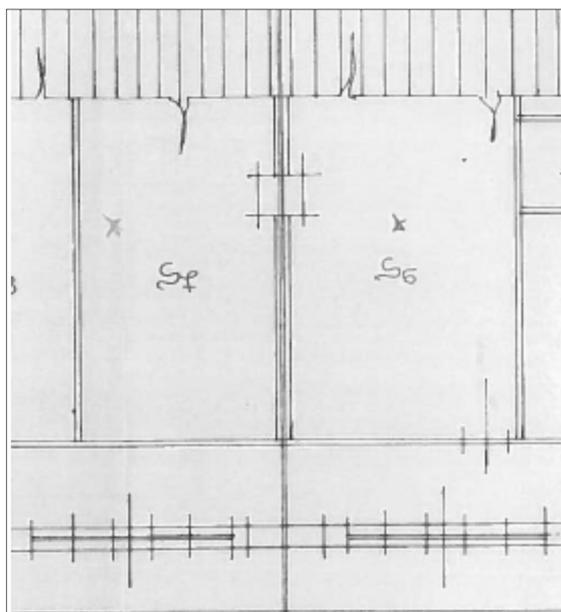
Planimetria di progetto relativa alla concessione edilizia in variante n. 53 del 04/11/1986.
